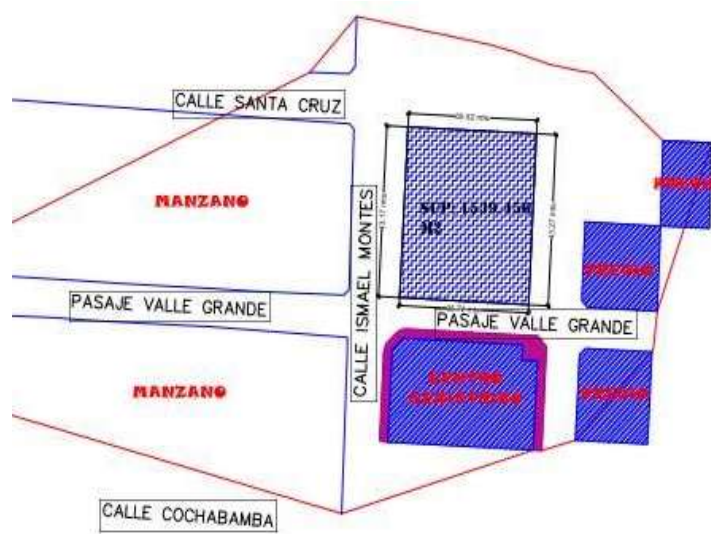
Detalle del lugar de emplazamiento, Fuente: Elaboración Propia.
